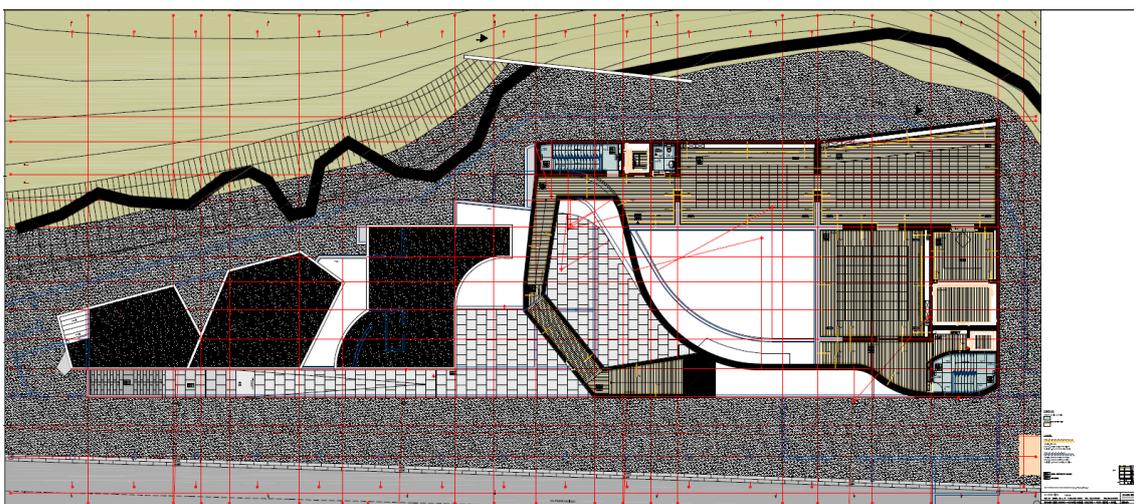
Planta Revestimento Piso (cota 22,15m) .
